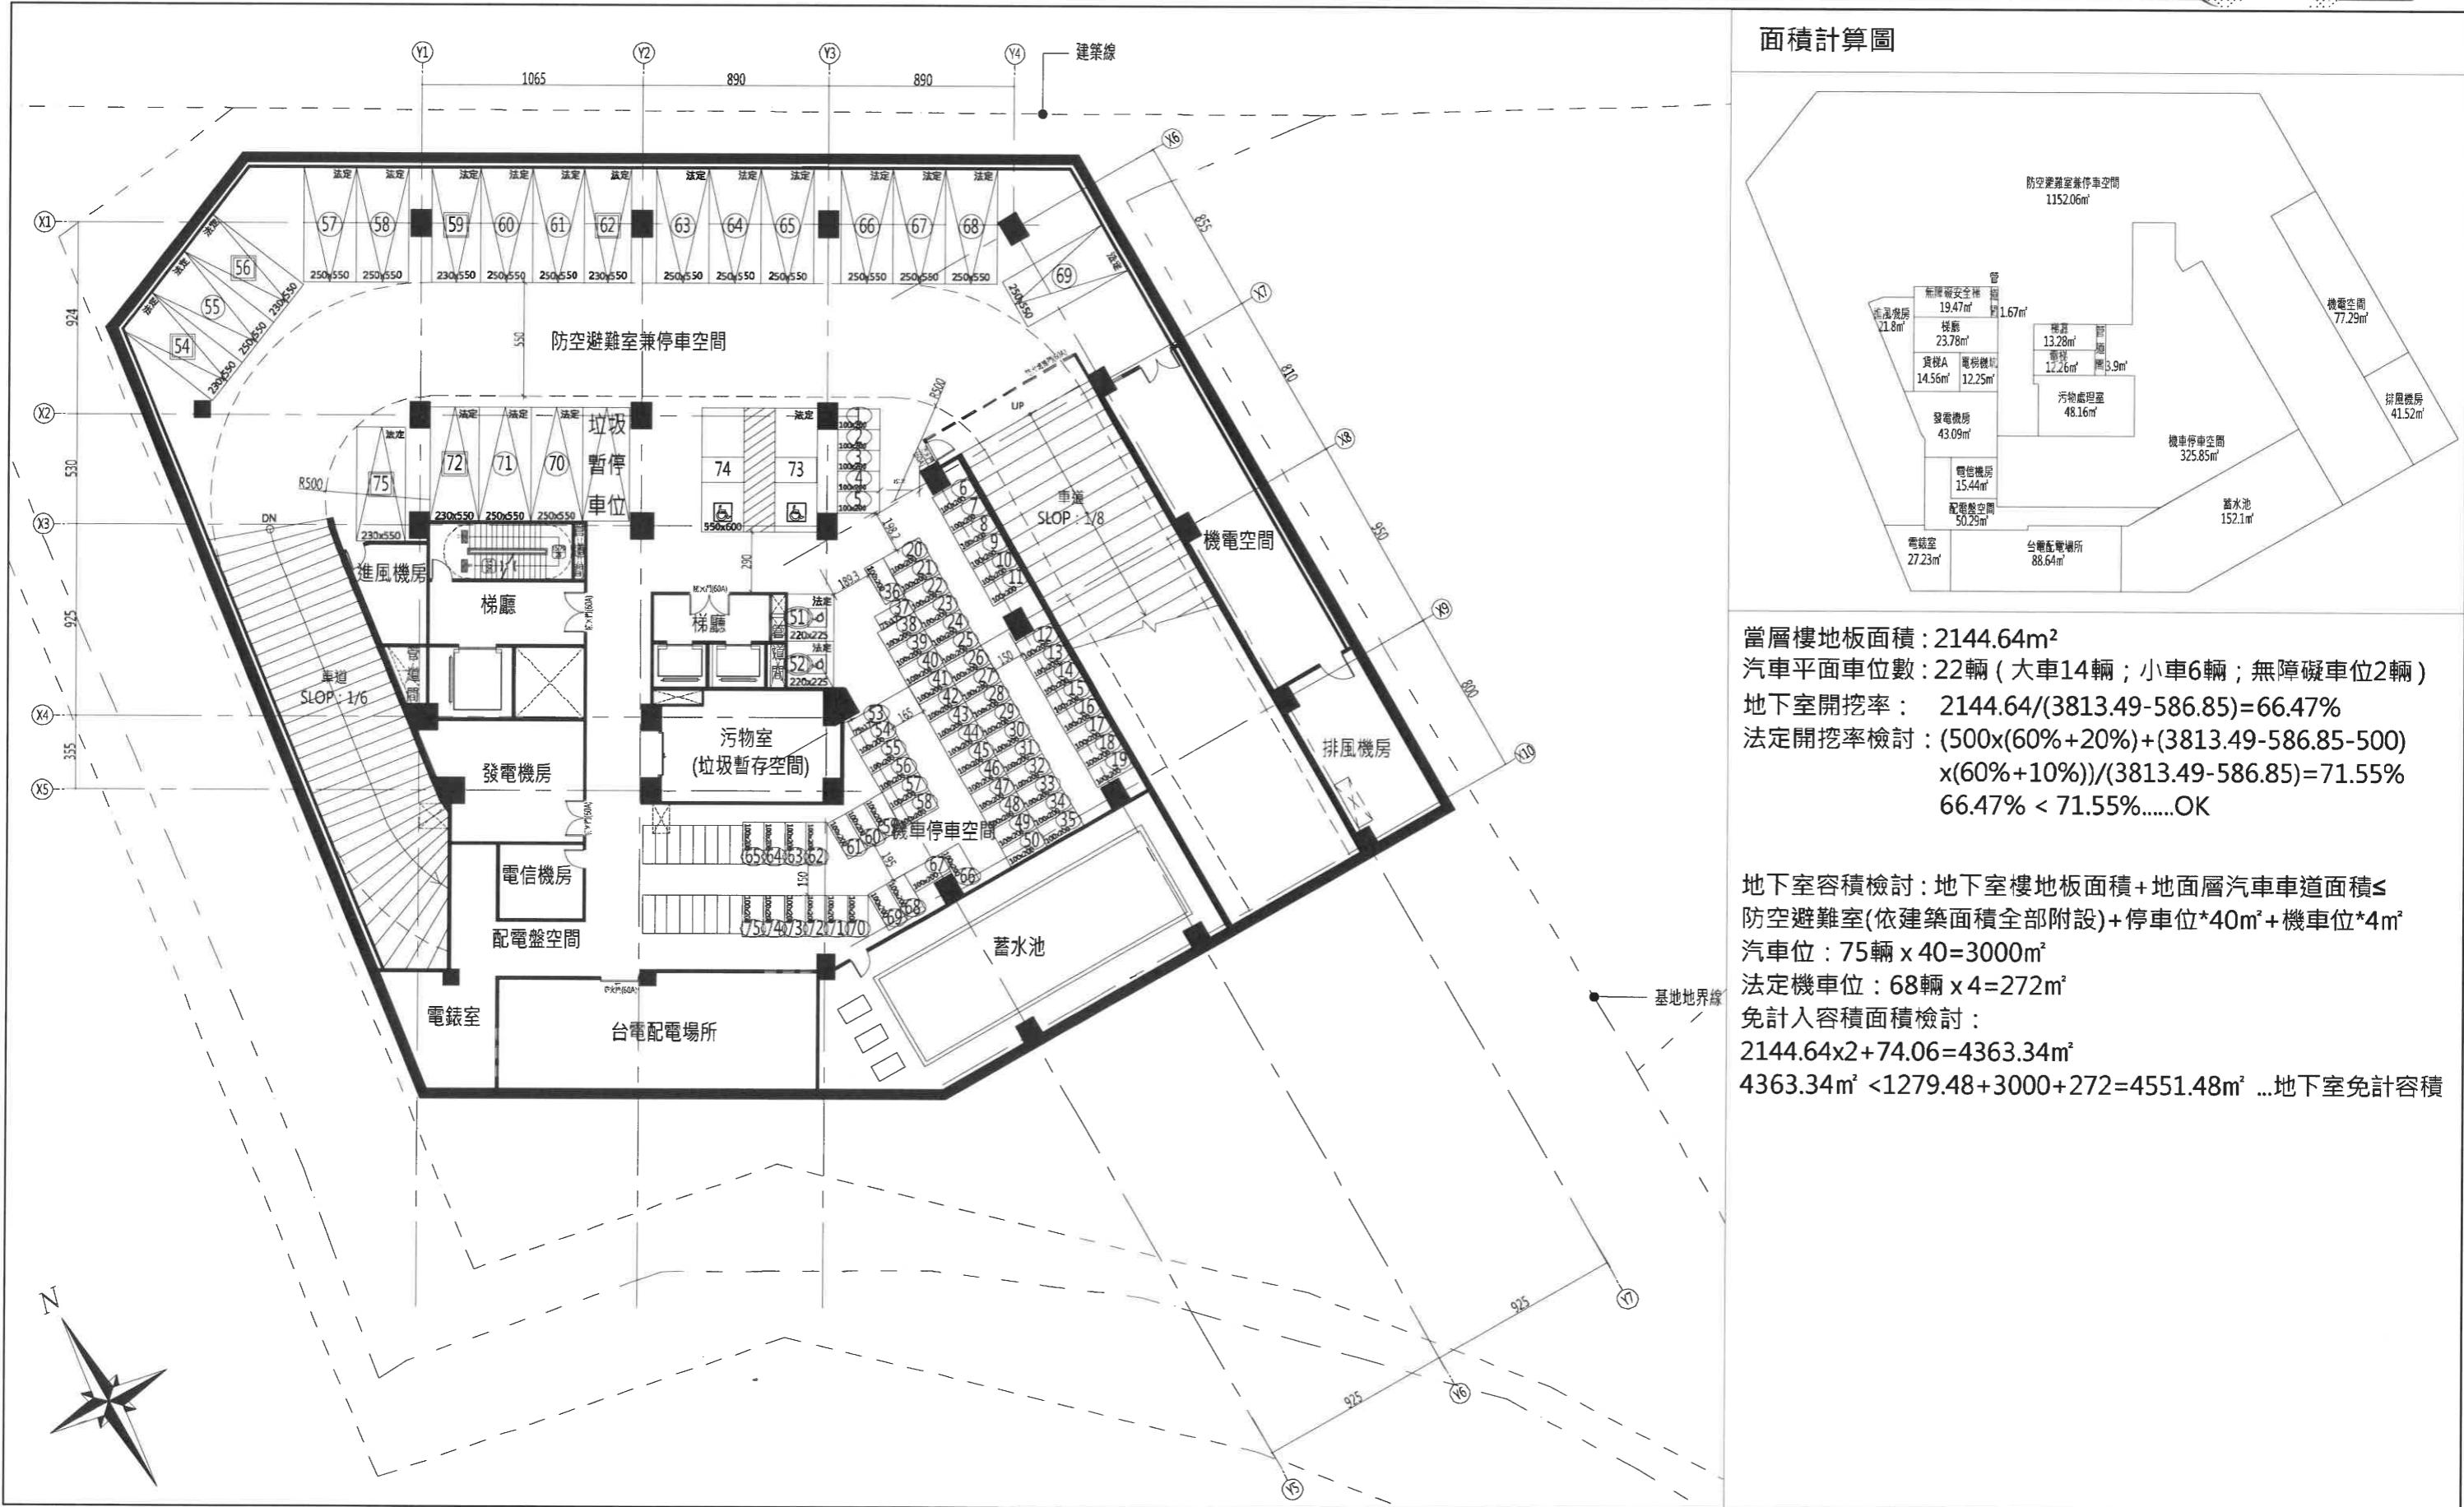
地下一層平面圖(原核定)(S : 1/300)
